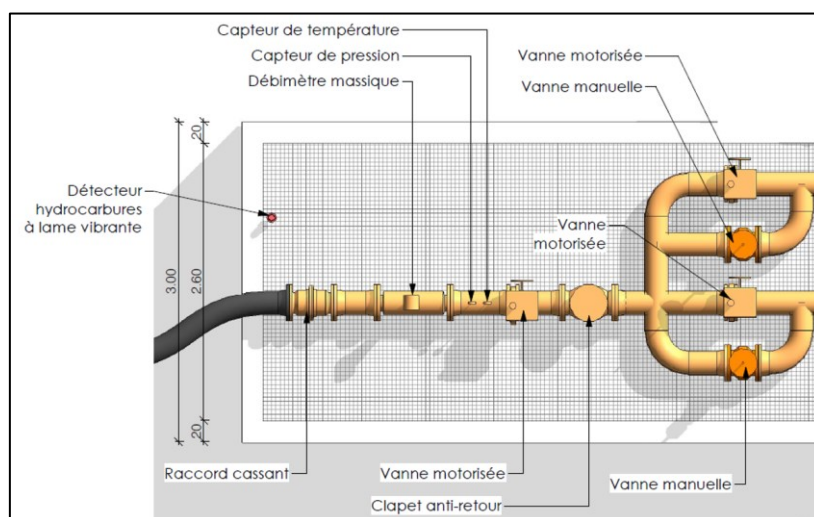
Arrangement des conduites sur le rack (GTI)
